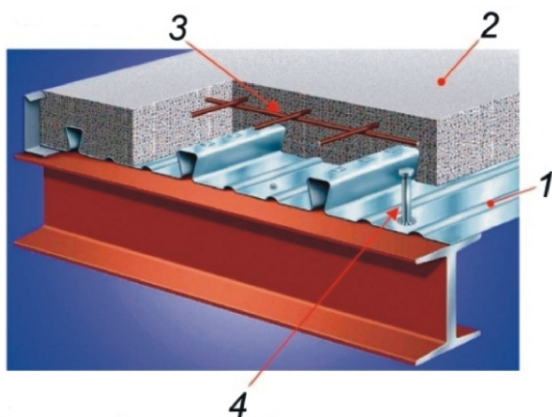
Залізобетонна плита перекриття із зовнішнім листовим армуванням:
